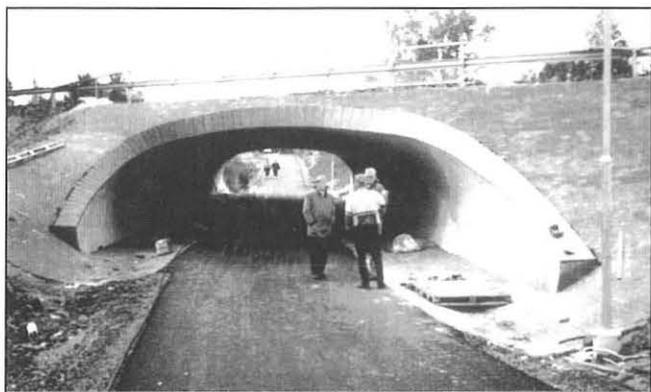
Eine im Spritzverfahren konstruierte Straßenunterführung in Kalajoki (Lemminkäinen Baugesellschaft)
